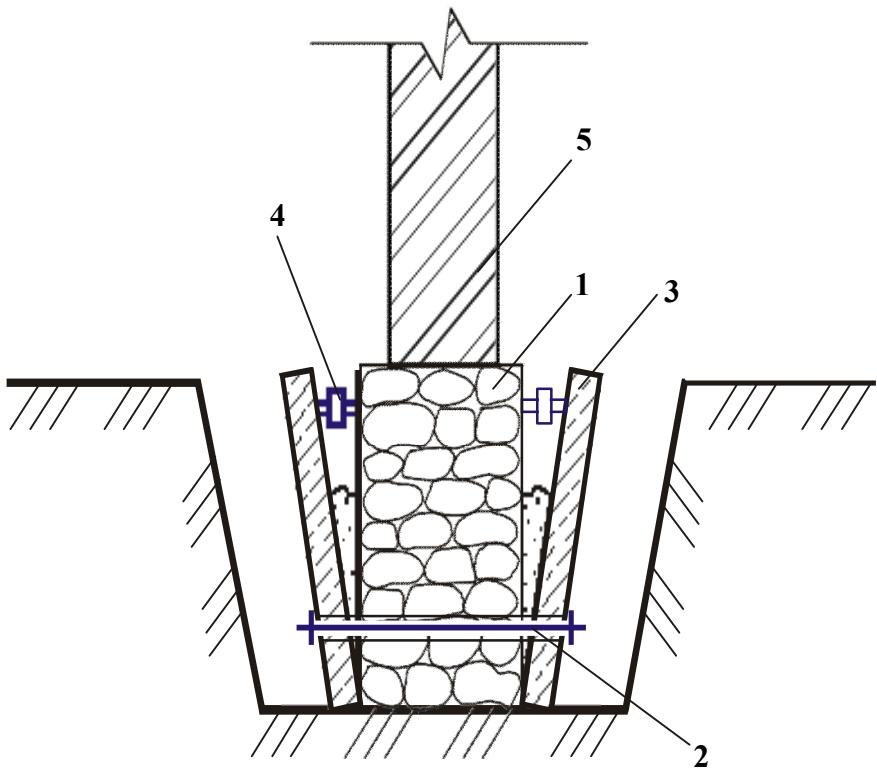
Збільшення площини обпирання фундаментів за допомогою залізобетонних відливів: 1 – фундамент; 2 – сталевий тяж; 3 – залізобетонний відлив; 4 – домкрат; 5 – стіна
